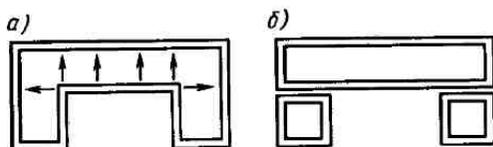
Схема разрезки здания со сложной конфигурацией в плане на самостоятельные отсеки:
